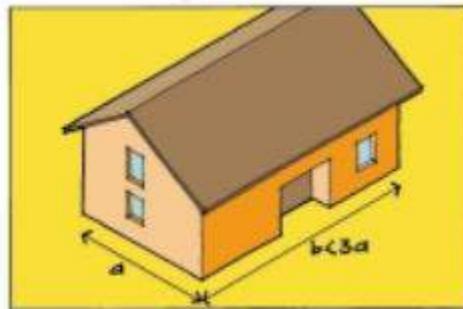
V. Baja irregularidad en planta (AIS, 2001).
